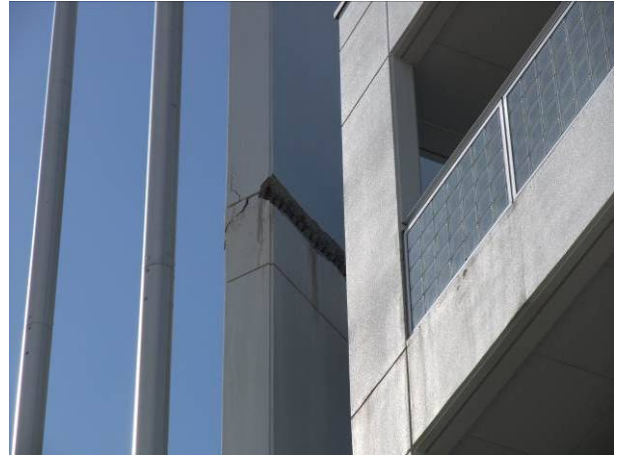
風除け壁のかぶりコンクリートの剥落
